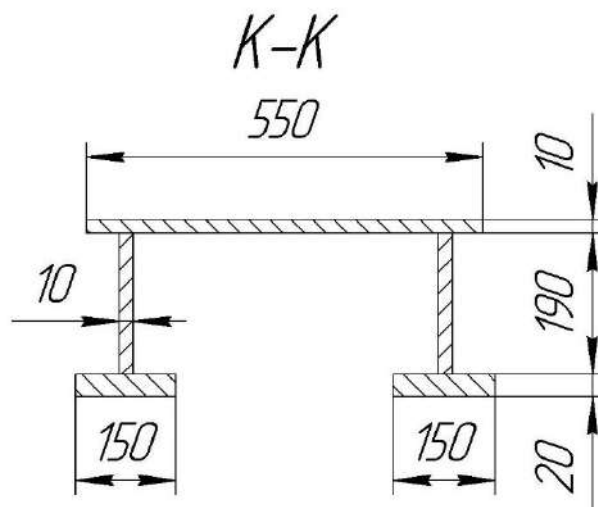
Перетин К-К поздовжньої балки E_1M_1
